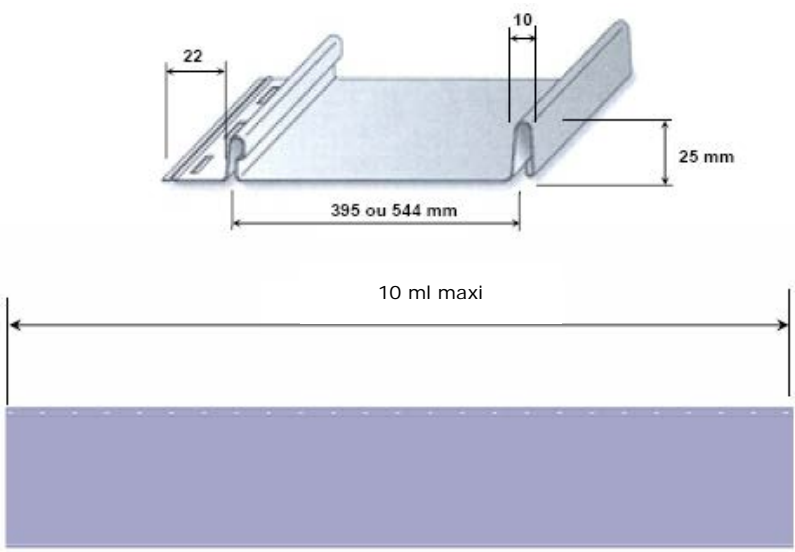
Profils Styl'inov® – Profil n° 3 - joint de 25 mm
